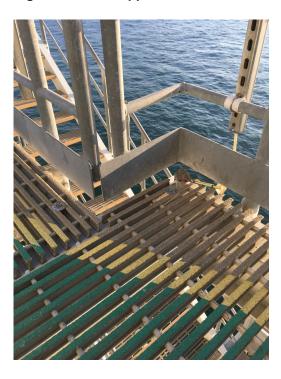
Consultez toujours les codes, les normes et les recommandations pertinentes pour la conception et l'installation des planchers de rebord
